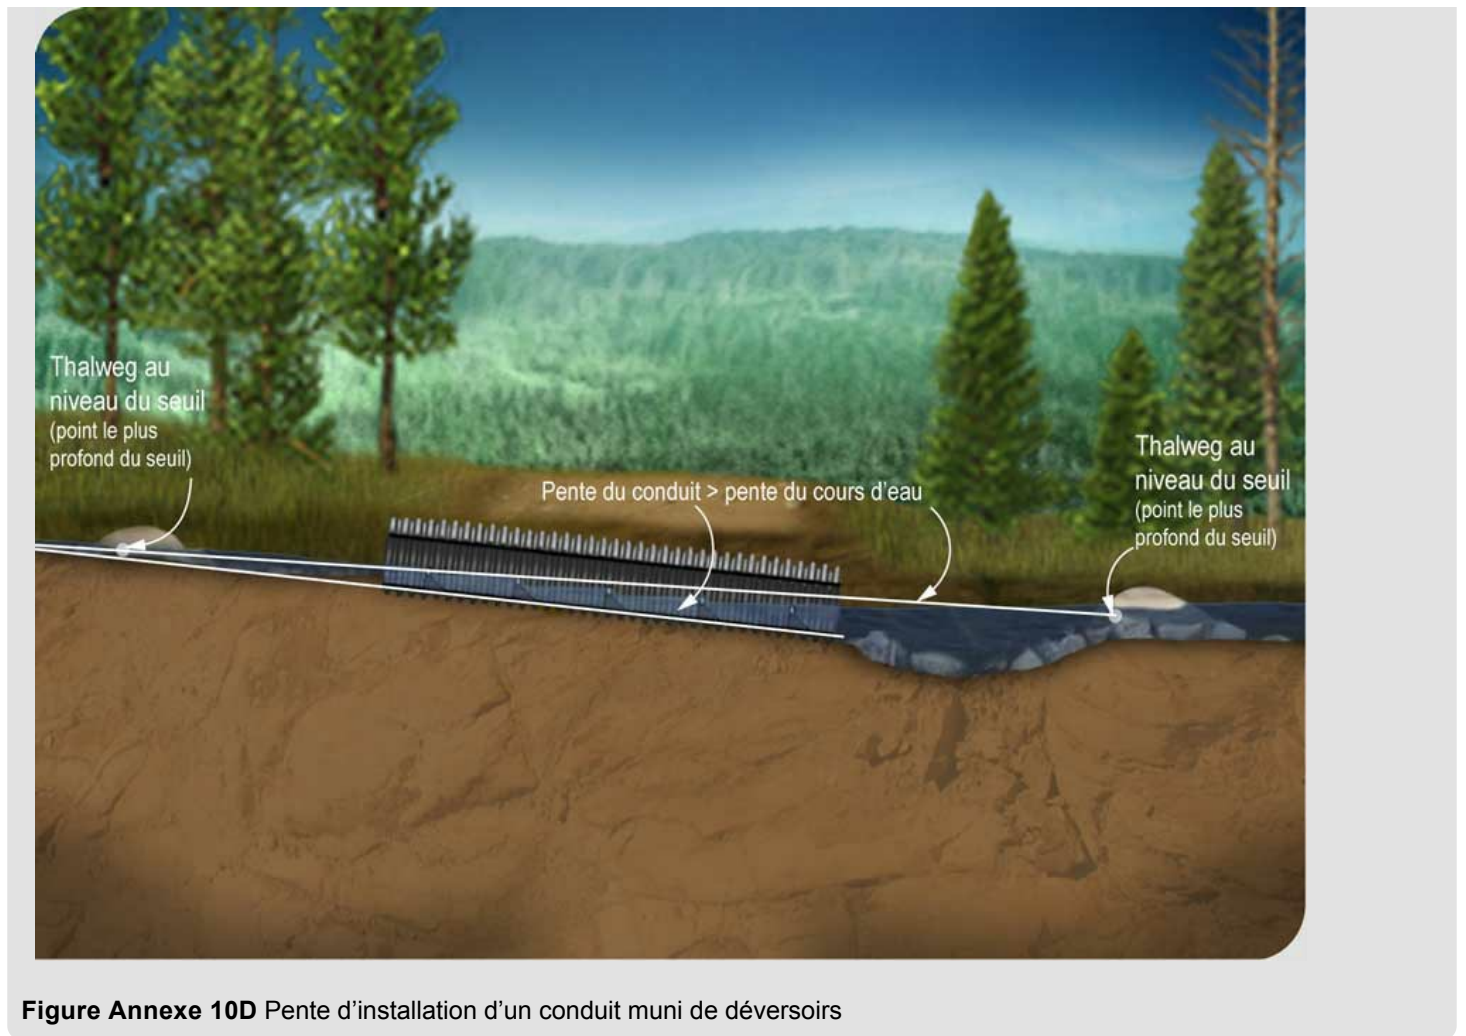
D Pente d'installation d'un conduit muni de déversoirs
